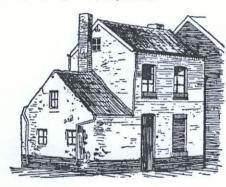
pignons (au centre et à droite) surmontés de rampants, plantches di roubîre.
